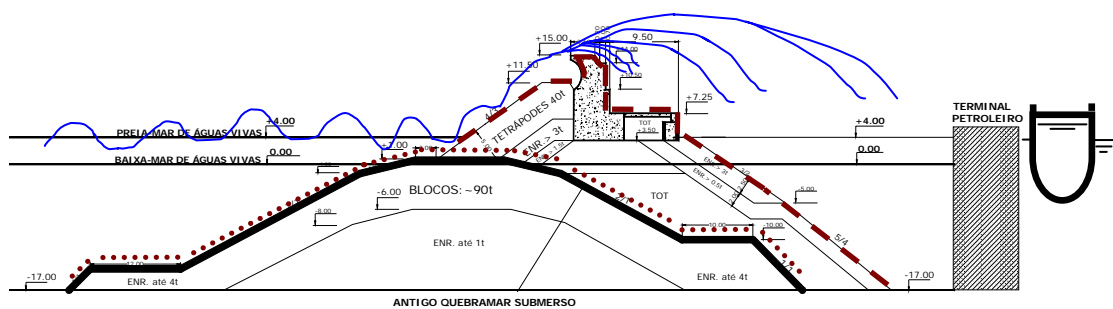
Perfil transversal de projecto com o quebramar submerso de protecção da cabeça do quebramar. (Pontado – 1º fase (1940); traço interrompido – 2º fase (1969)).
